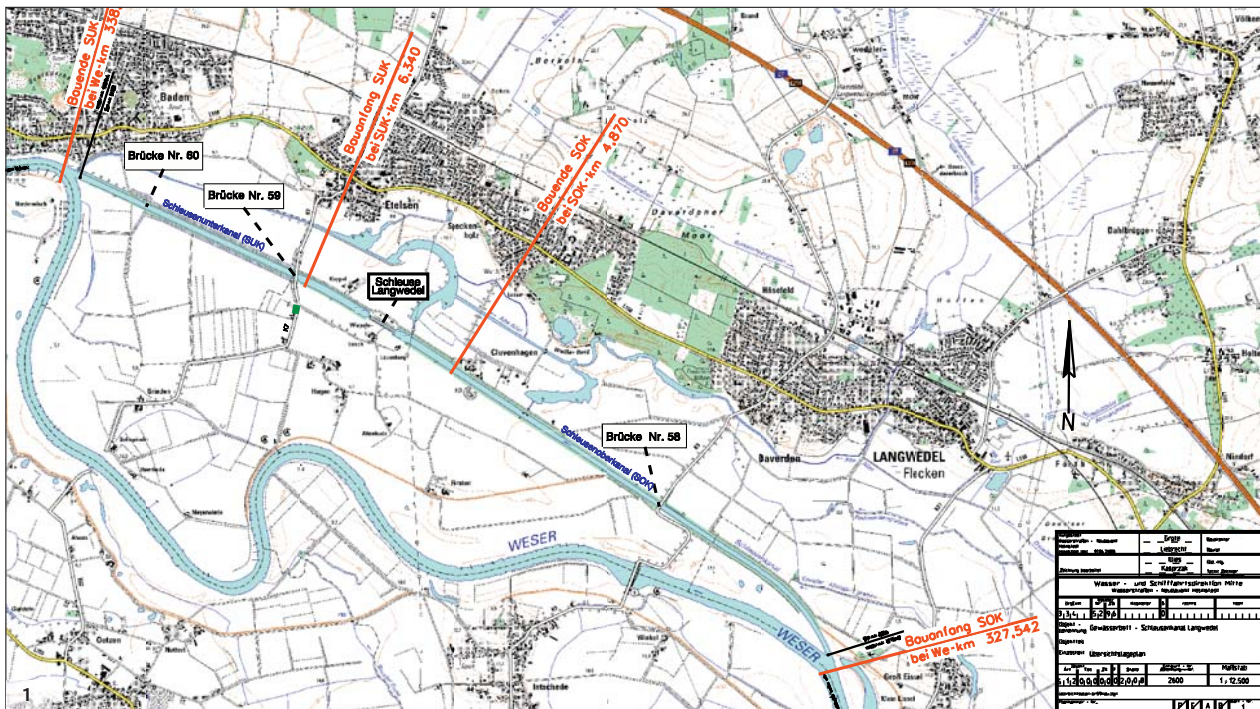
Übersichtslageplan Schleusenkanal Langwedel
